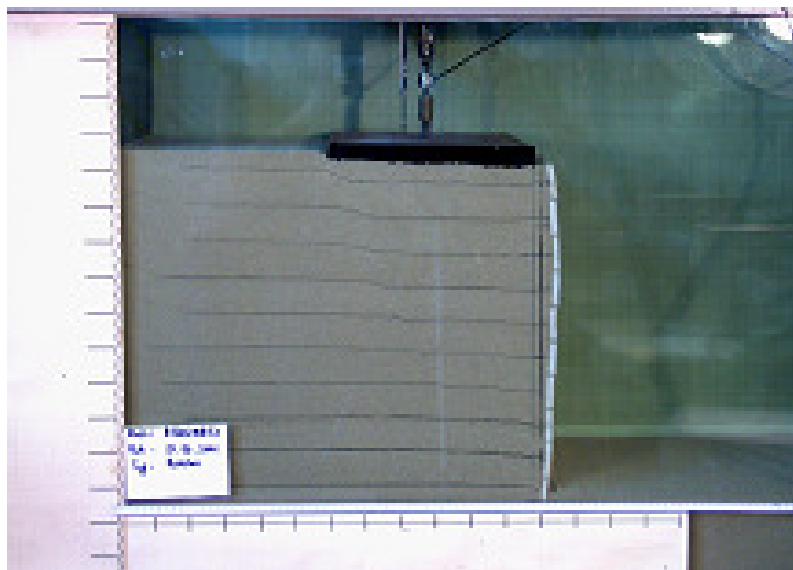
Model ściany oporowej z gruntu zbrojonego badany w laboratorium IBW. Ciemne warstewki odpowiadają zbrojeniu. Widoczny jest początek zniszczenia konstrukcji (fot. M. Kulczykowski)
